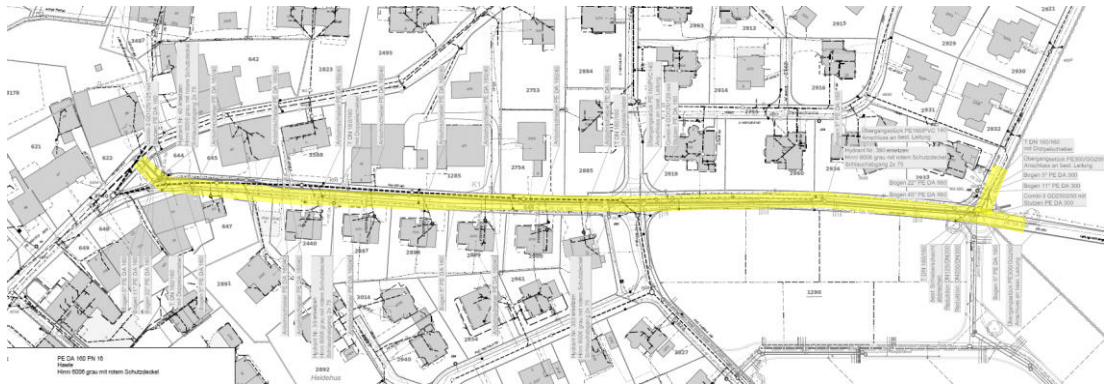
Situation Wasserversorgung / Löschschutz Leigrubenstrasse
